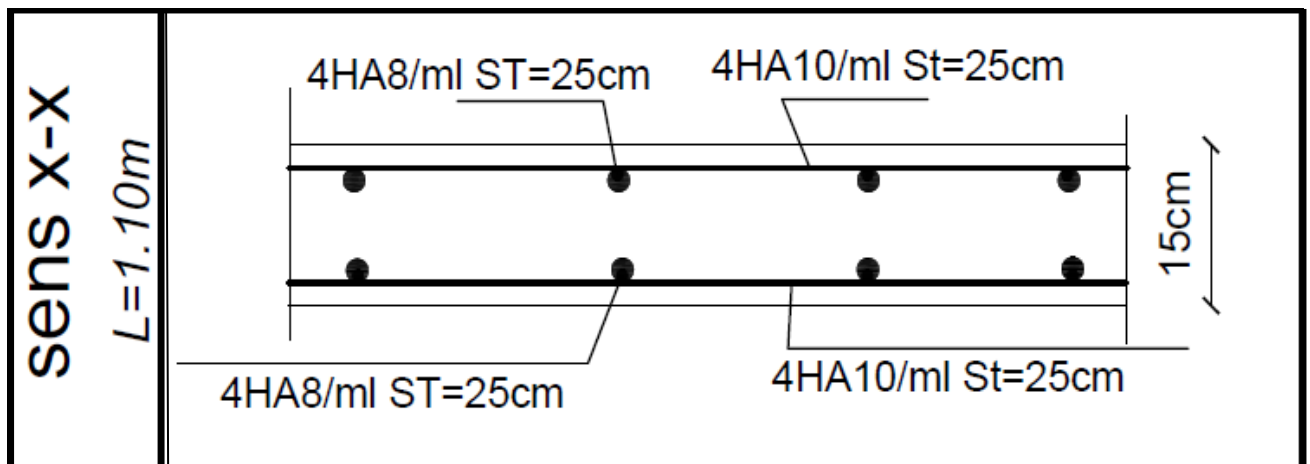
plan de ferrailage de la salle machine suivant x-x
